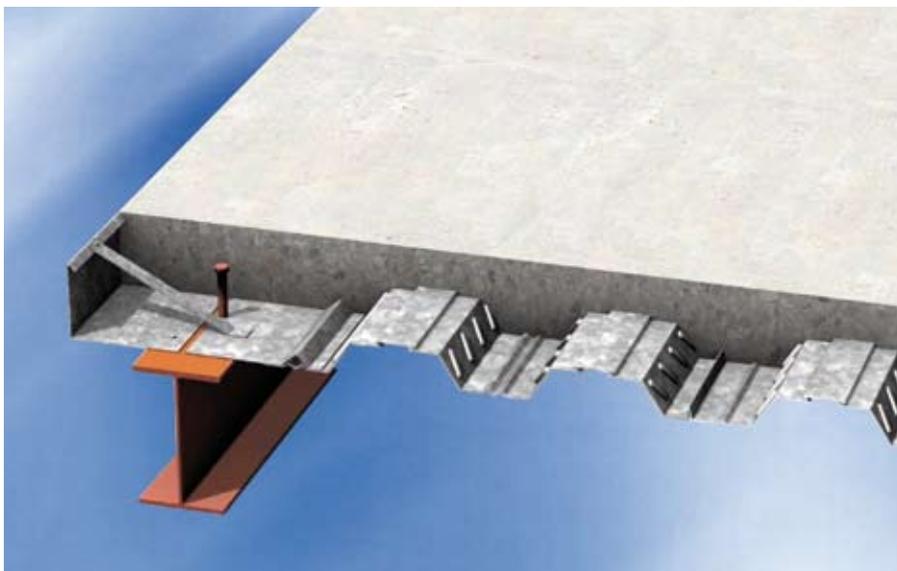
Dalle mixte typique et poutre de rive mixte en acier Kingspan
